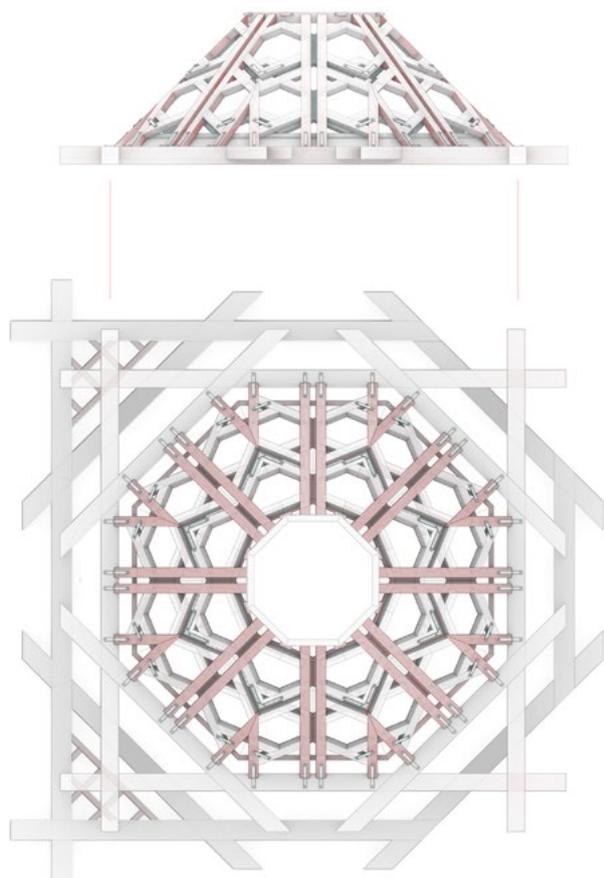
Planta y alzado de los elementos estructurales. Estribos, pares, péndolas y herrajes.
